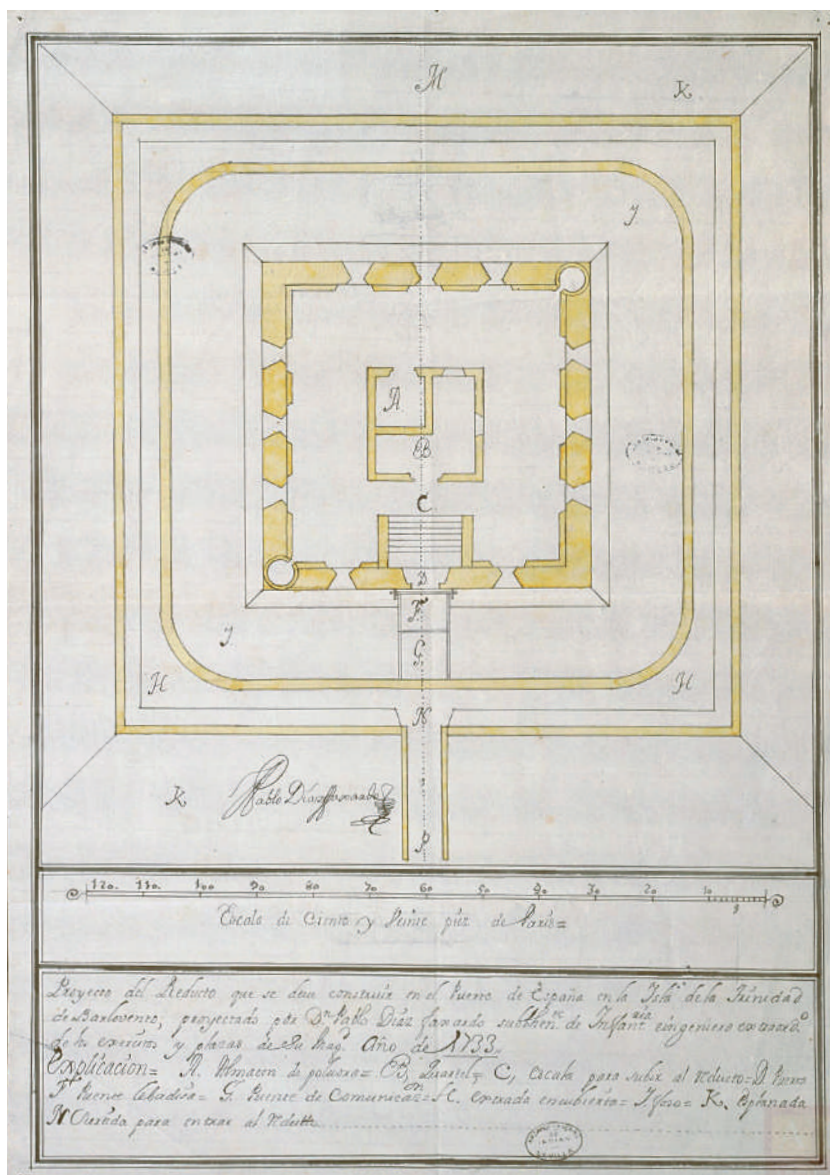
Planta del reduto para Puerto España (Díaz Faxardo, Pablo. 1733. «Proyecto del reduto que se deue construir en el Puerto de España, en la ysla de la Trinidad de Barlovento, proyectado por don Pablo Díaz Faxardo, subtheniente de Ynfantería e ingeniero extraordinario de los exércitos y plazas de su magestad». Puerto de España, 1733. En AGI, sign. MP-Venezuela, 81)
